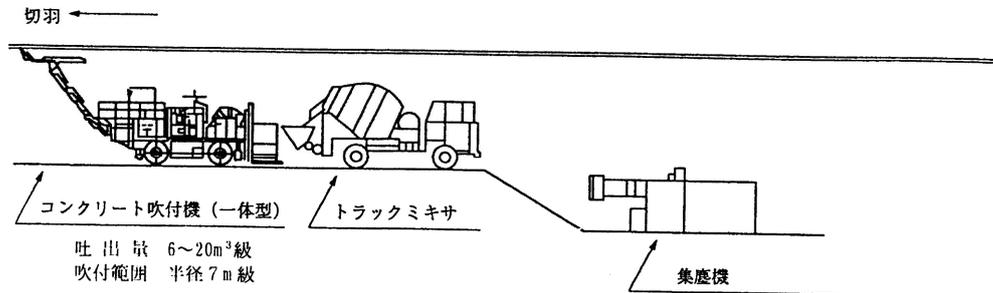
吹付コンクリート施工機械の配置例(参考)
